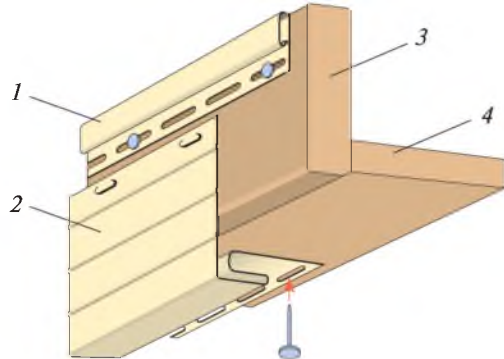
Крепление целой J-фаски к причелине: 1 — финишный профиль; 2 — J-фаска; 3 — причелина; 4 — деревянная обшивка карниза
